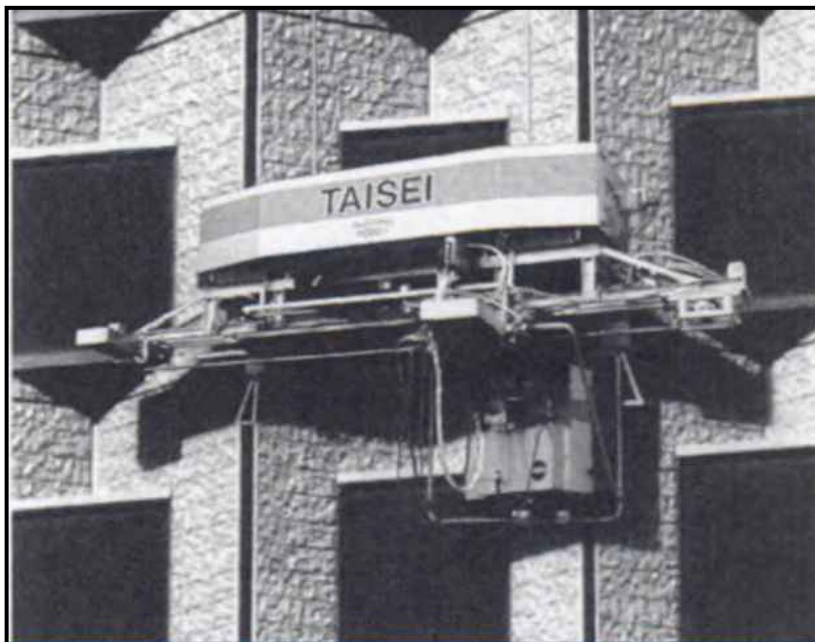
Robot de pintado fachadas Taisei. *Construction Robots. The search for new building technology in Japan.
